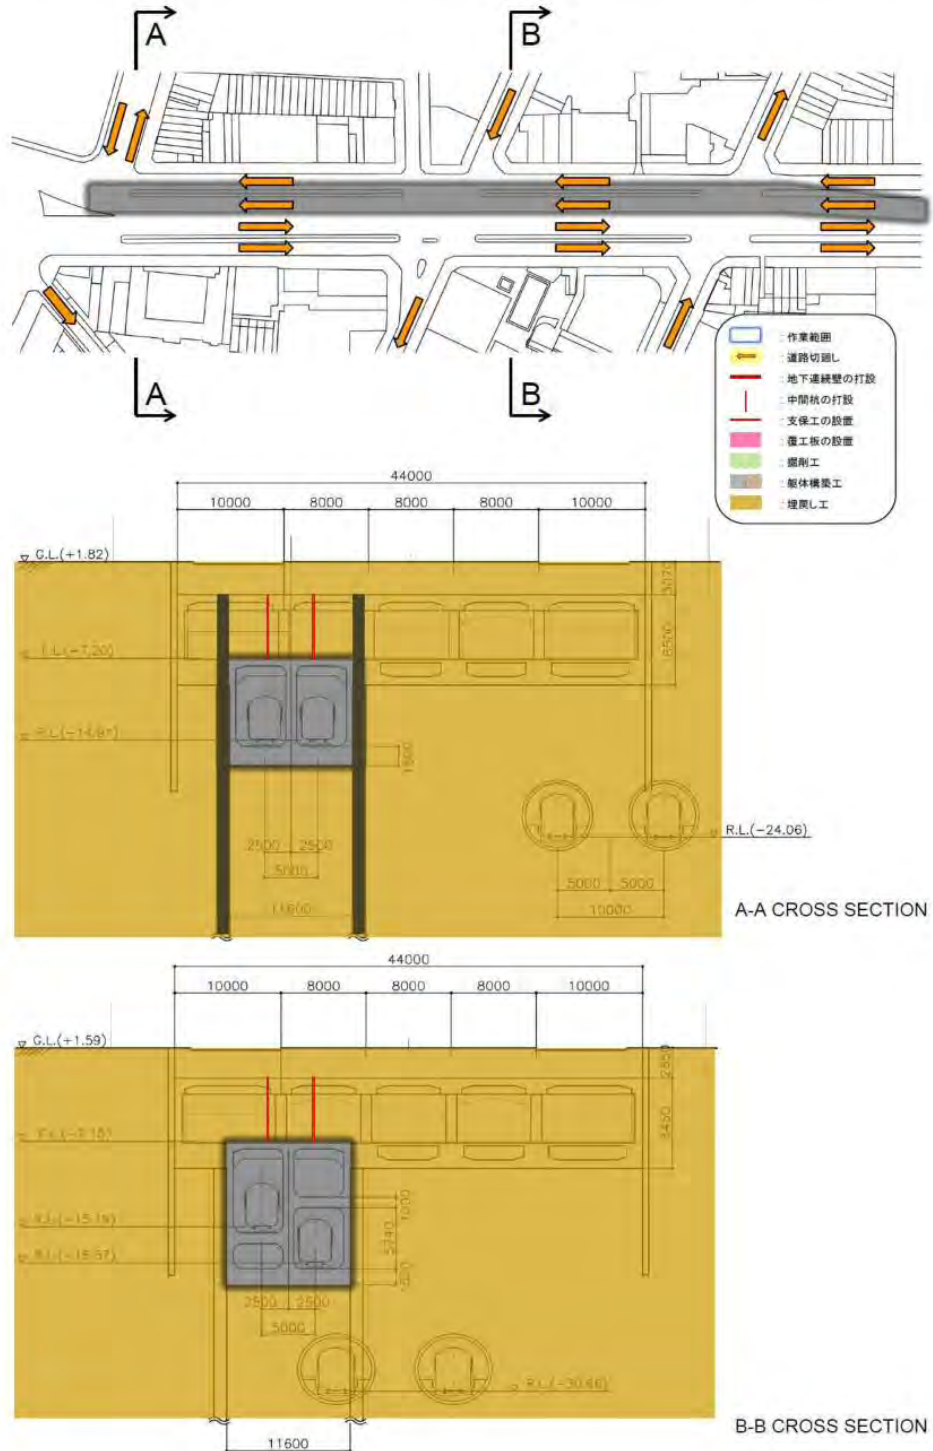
レロイ通り地区の都市鉄道1号線と地下街の施工手順図 (その 7/14)
